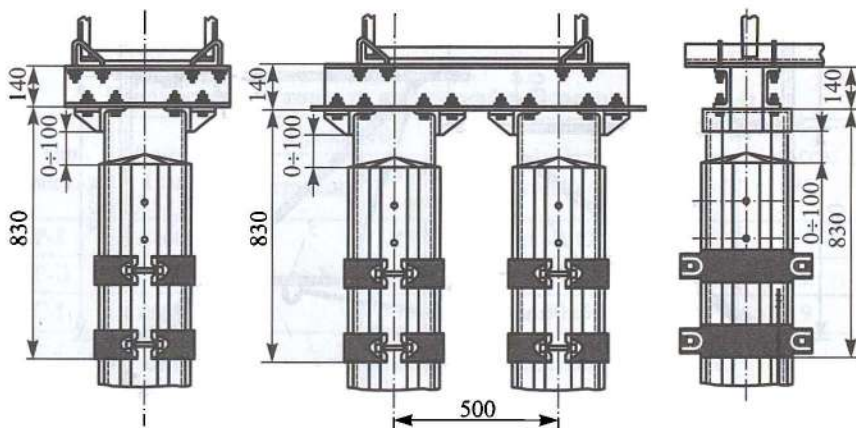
Крепление ригеля на вершинах стоек:
